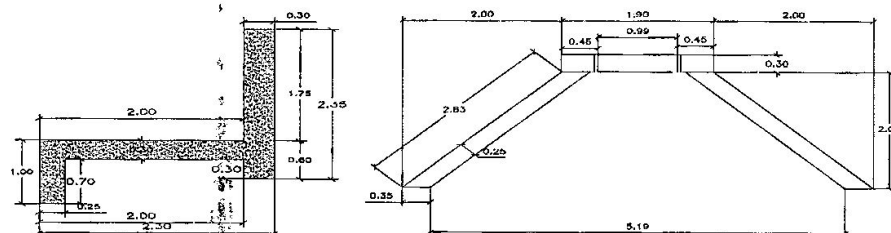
Vista del alzado del Encofe y Planta del Encofe y Descote. Fuente: Diseños entregados por el solicitante.
